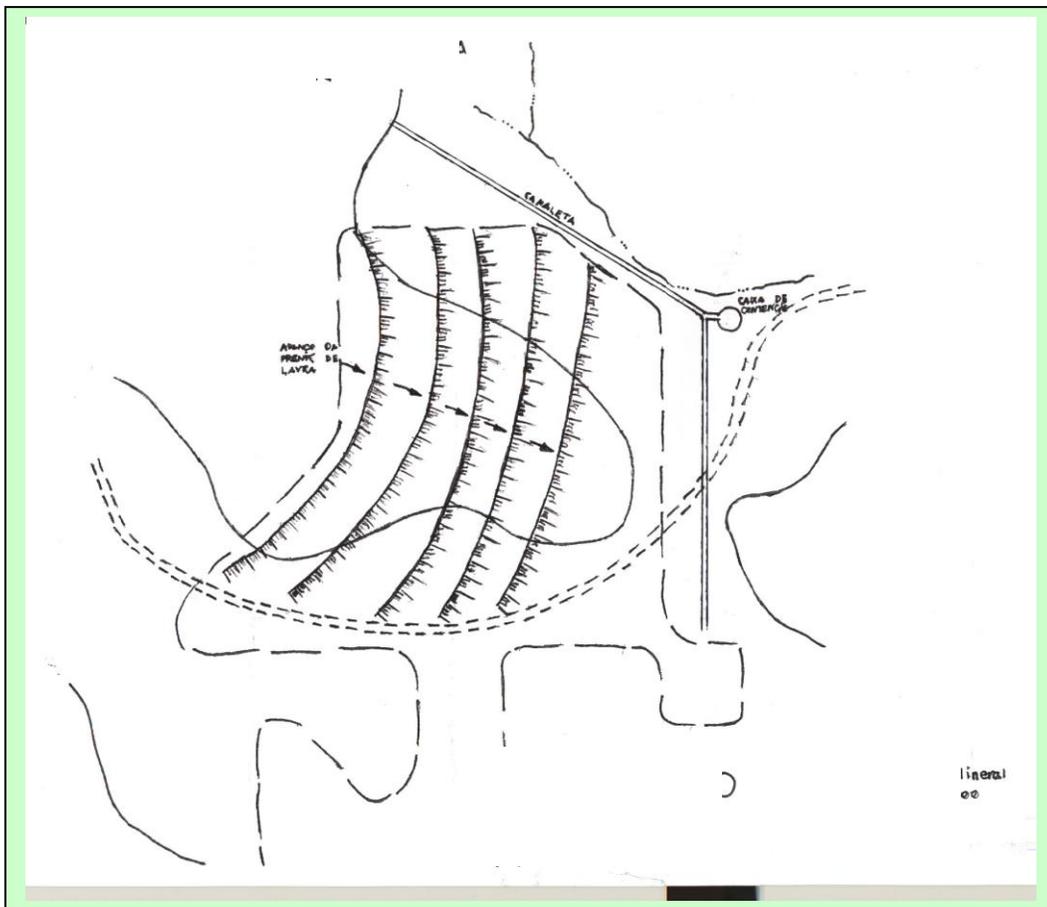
Infra-estrutura projetada para a área 285 – Área de Intervenção
